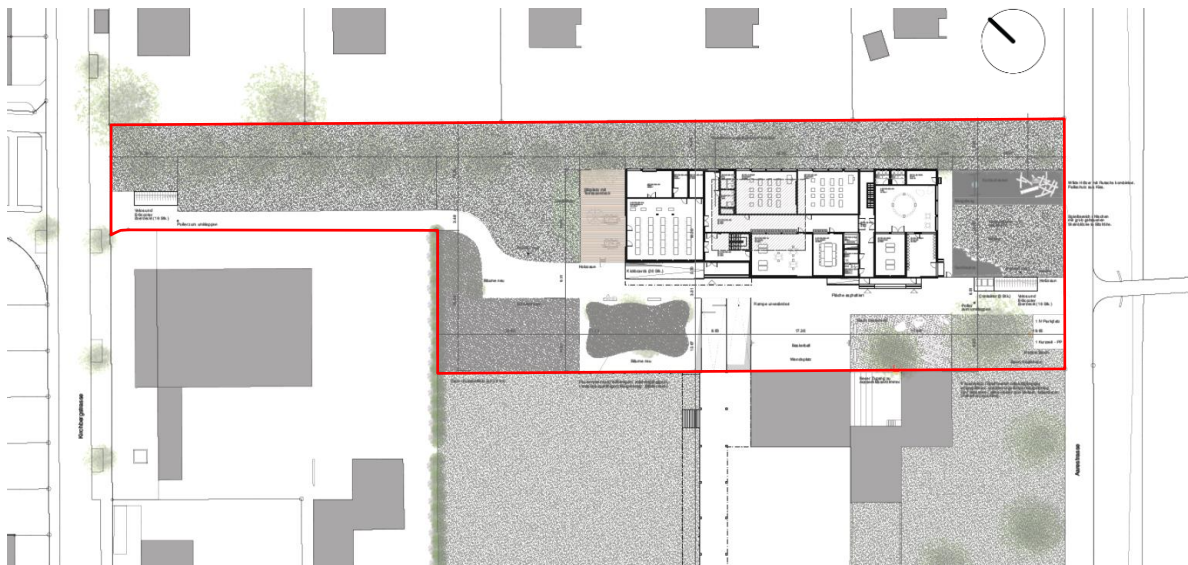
Situationsplan Modulbau mit Kirchbergstrasse links und Aareufer rechts (Perimeter rot umrandet)
